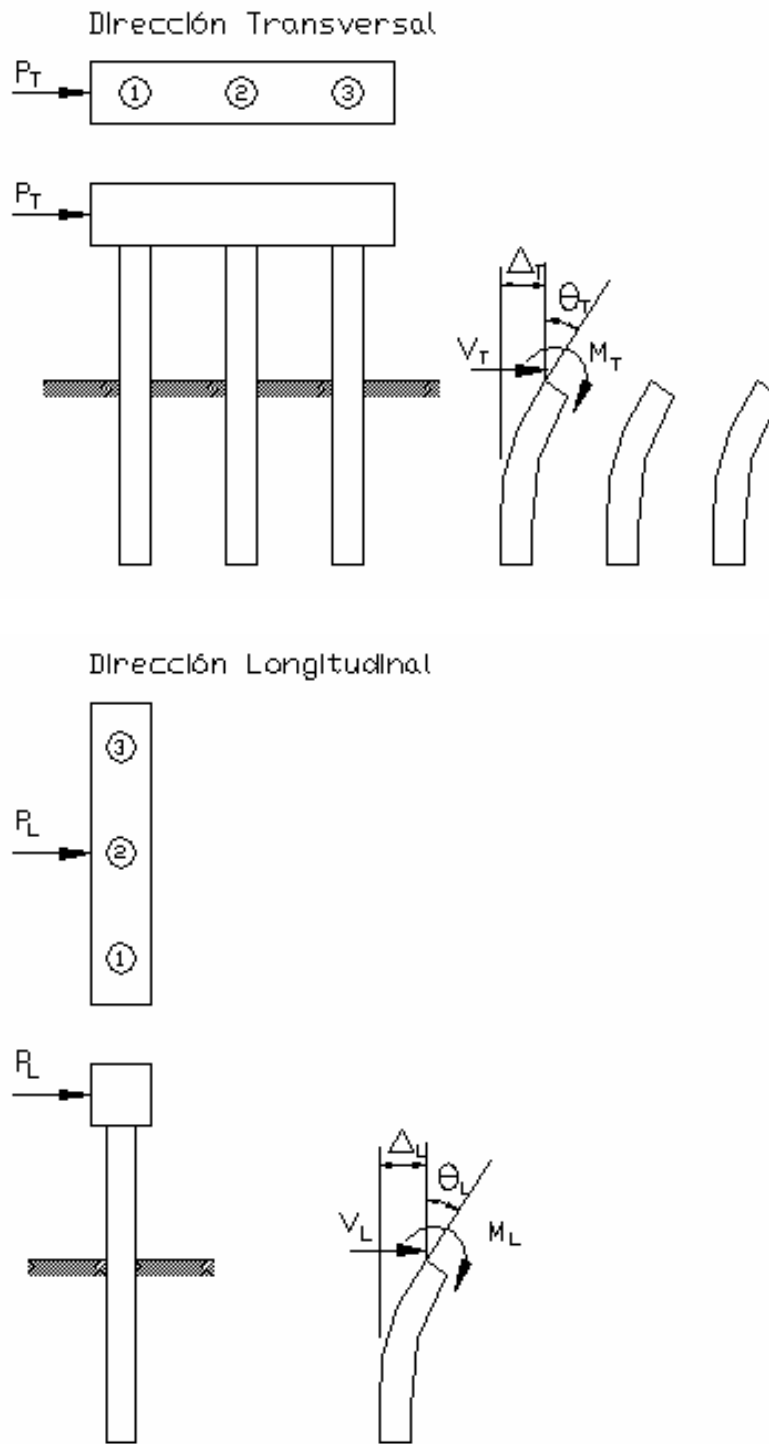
Pilastra bajo carga lateral en las direcciones transversal y longitudinal
